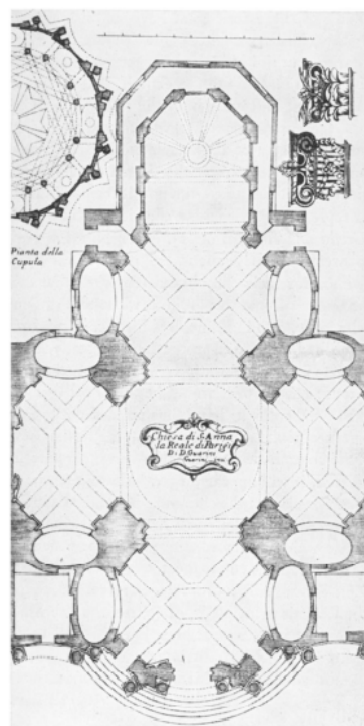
Grundriss Saint Anne la- Royale
